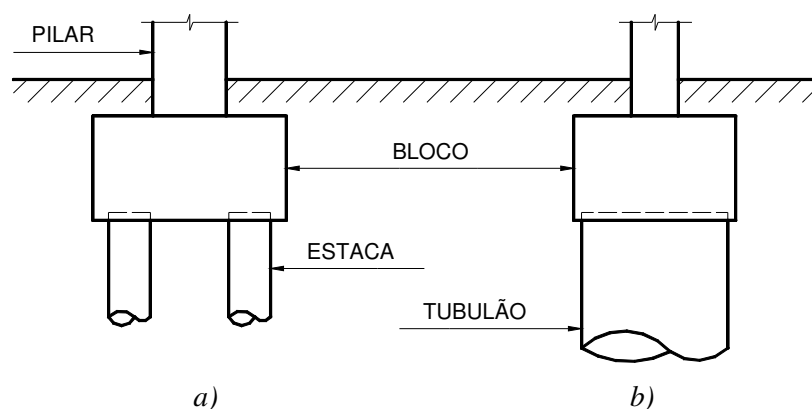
Bloco sobre: a) estacas; b) tubulão.
